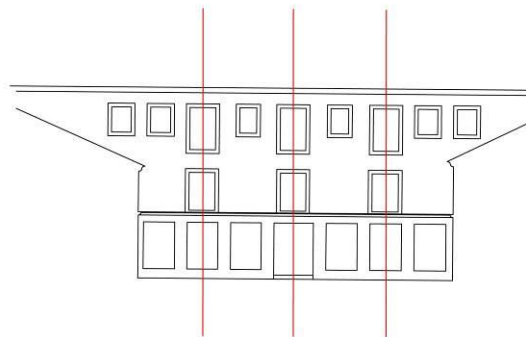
Estudo de composição da fachada sudeste do claustro.
